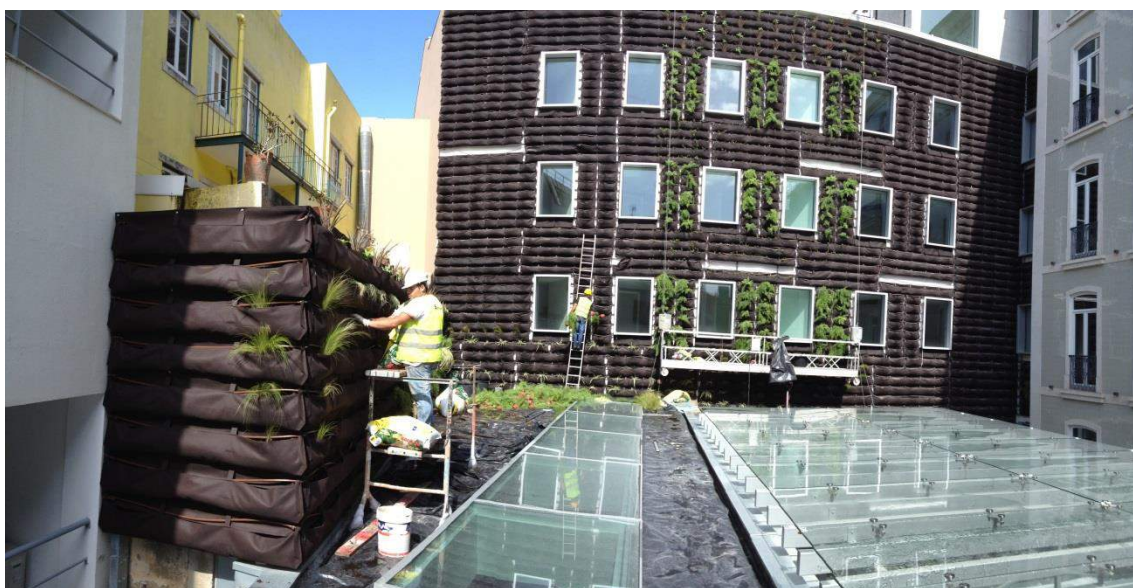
Fase 4 da construção da parede viva do Bessa Hotel Av. Da Liberdade(Março de 2014)
